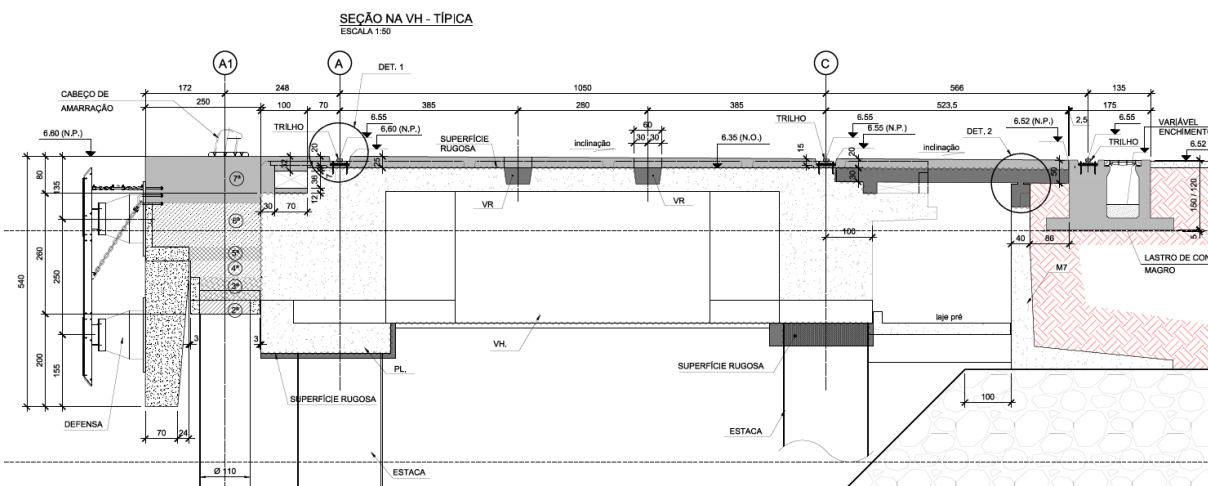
Corte transversal - formas da superestrutura com reforços propostos (seção apoio).
